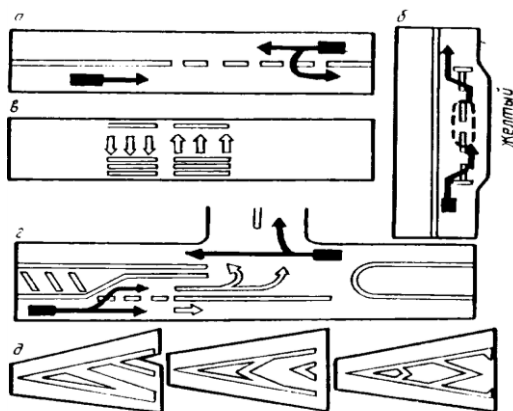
Разметка проезжей части: а – направление движения; б – остановка автобусов; в – пешеходный переход; г – перестроение потоков; д – направление движения по полосам.
